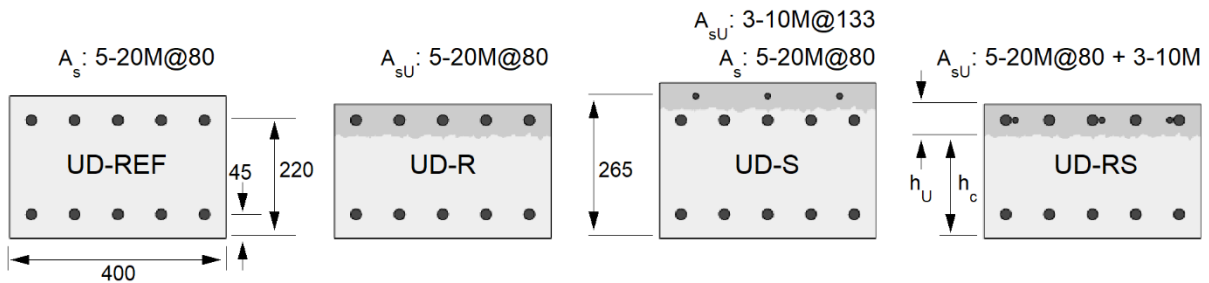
Section des dalles unidirectionnelles testées (dimensions en mm)
